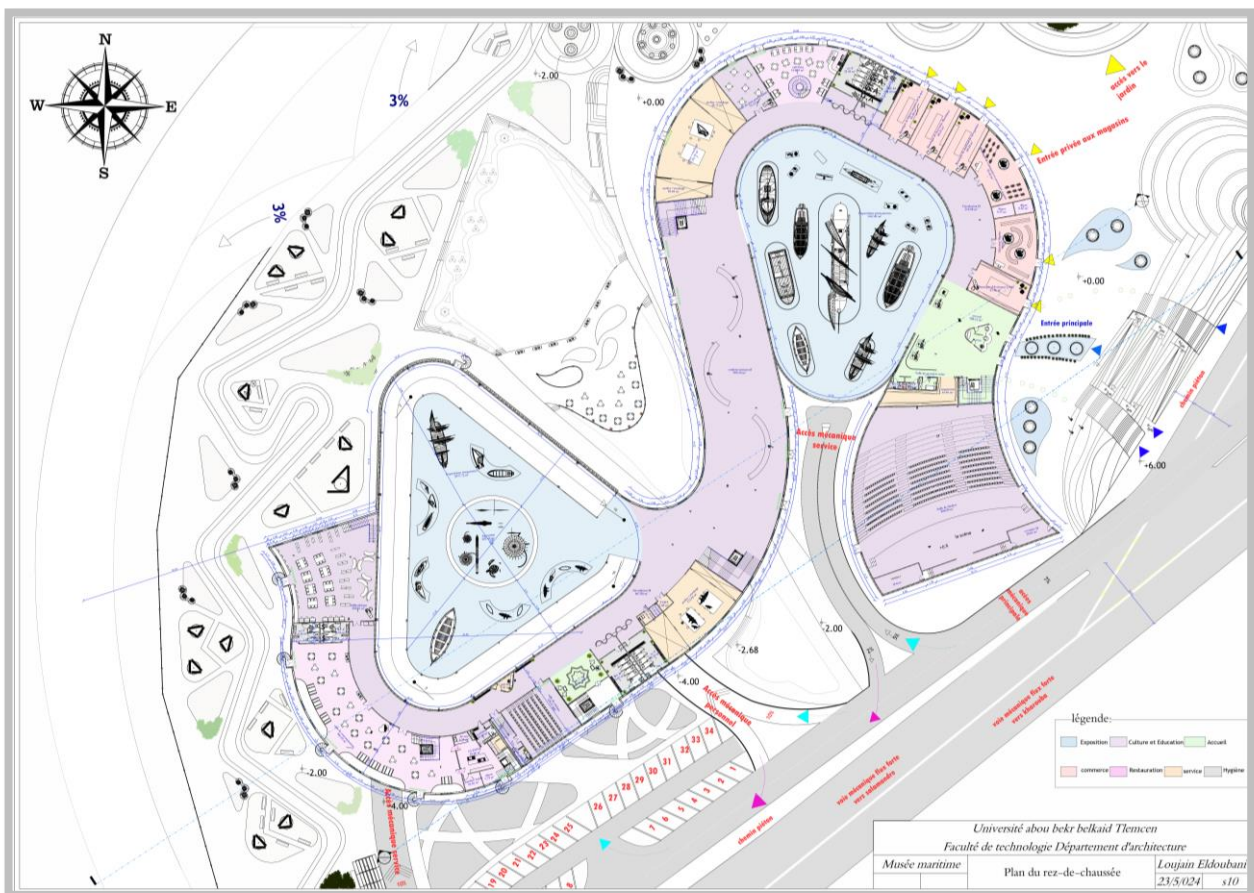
Plan du rez-de-chaussée (Voir Annexe).
